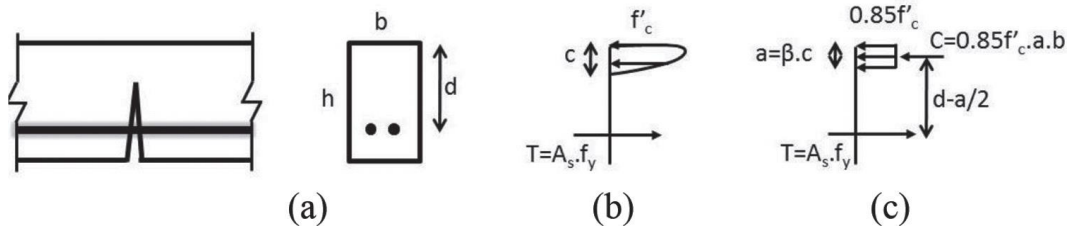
ACI 544.4R - Fig. 4.4—Schematics of stress block for a cracked reinforced concrete flexural member without fibers: (a) reinforced concrete beam section; (b) actual distribution of normal stresses; and (c) simplified distribution of normal stresses.
